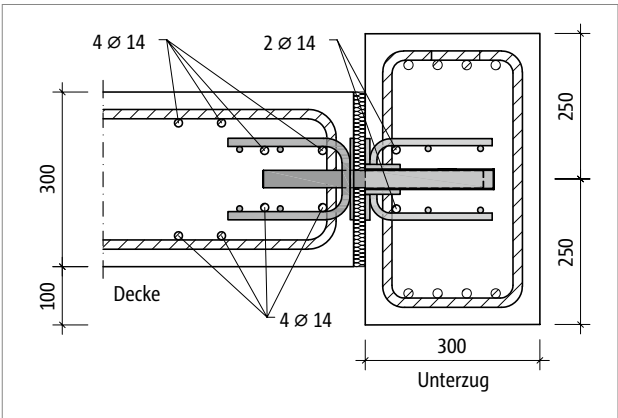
Schnitt durch Anschluss Decke–Unterzug mit Bewehrungsanordnung
